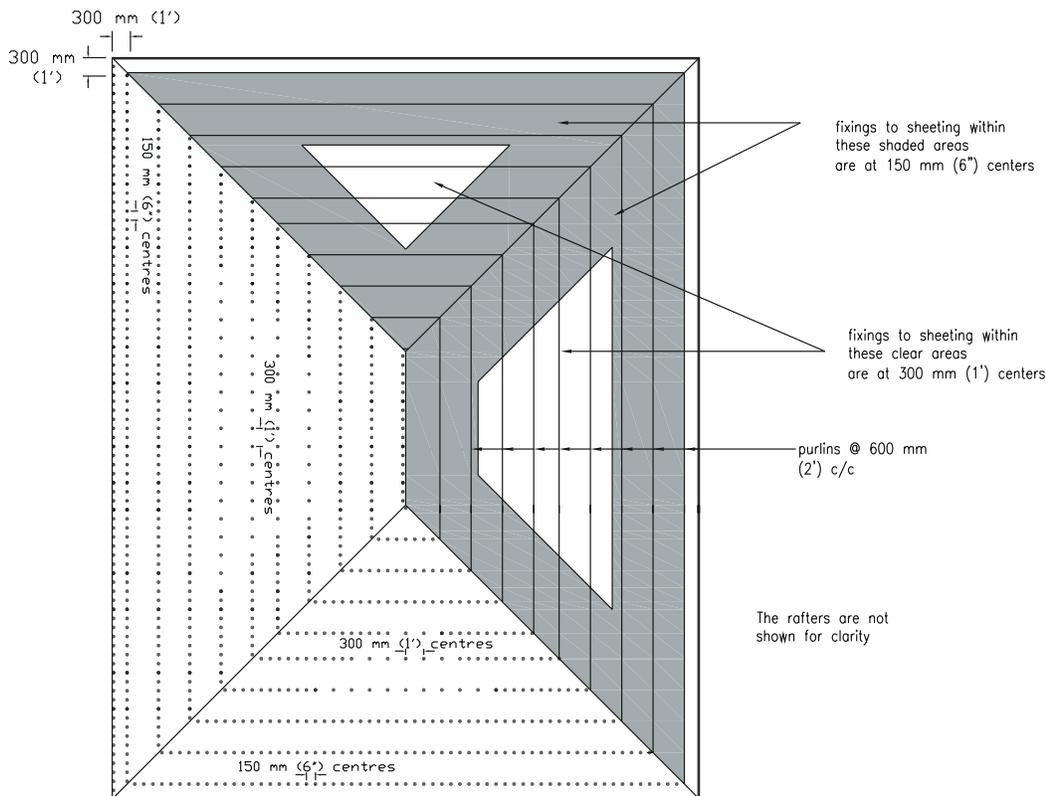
Détails d'assemblage du toit pour une toiture de 9 m de portée
